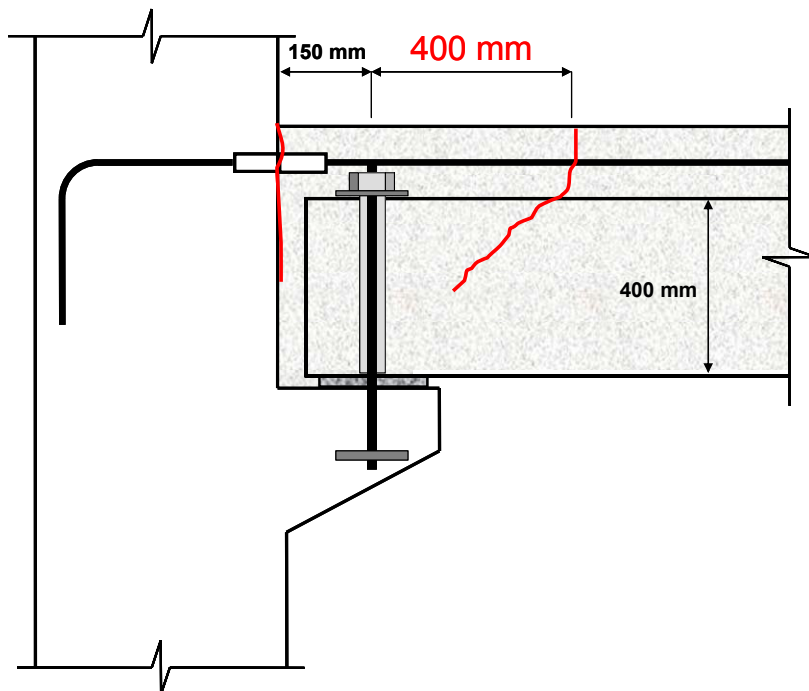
Localização da fissura que caracteriza o comprimento da região da ligação.
